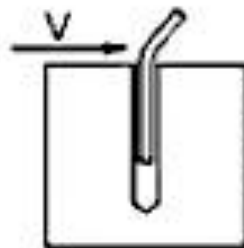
Fallo por deslizamiento del anclaje (Eligehausen et al. 2006) (10).
